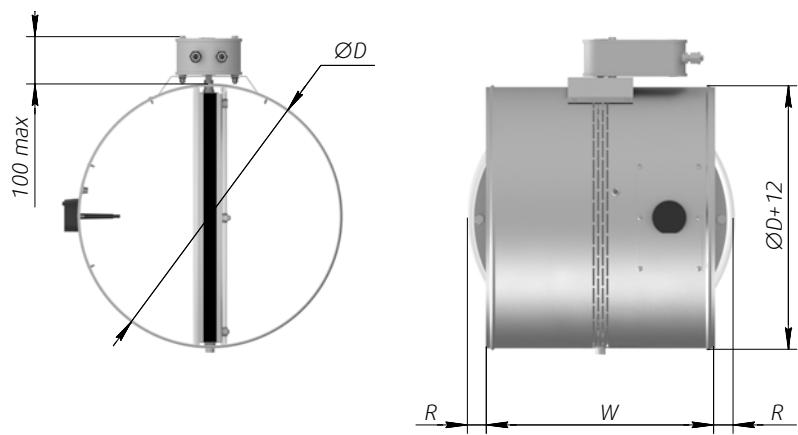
б. Размеры ниппельного клапана HELMER, EI90
